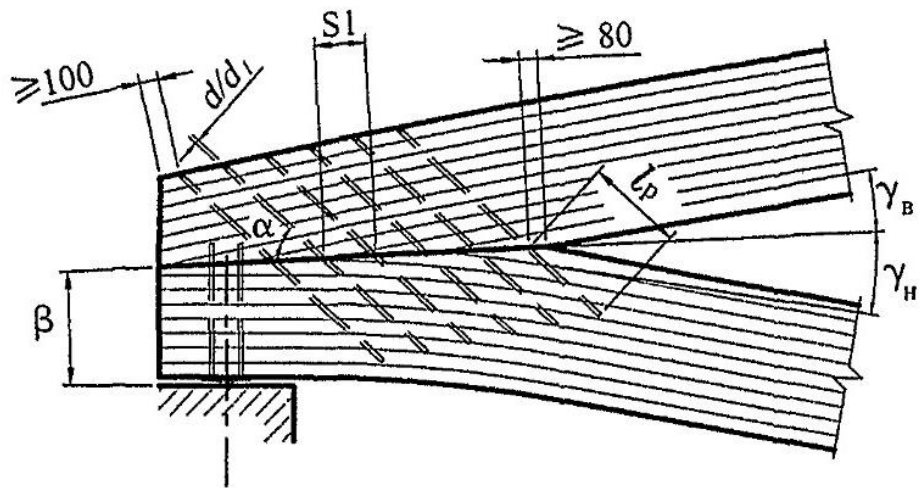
Опорный узел клееной фермы, выполненный на вклеенных арматурных стержнях
